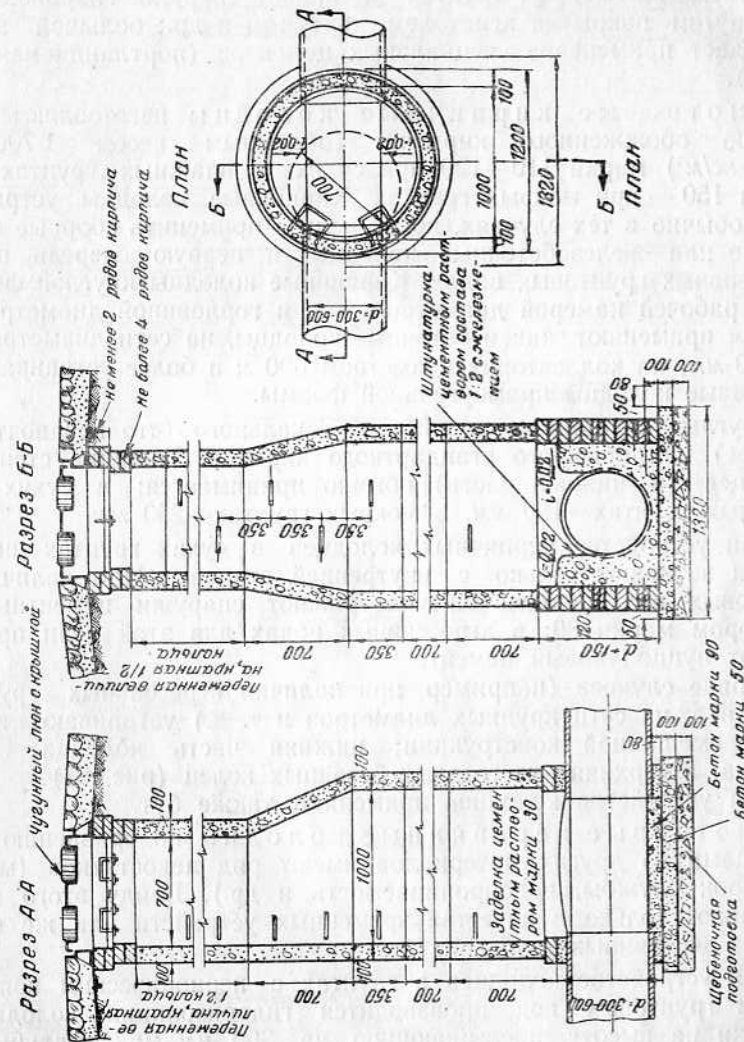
Колодцы из бетонных колец в сухих грунтах для труб диаметром 500—600 мм
